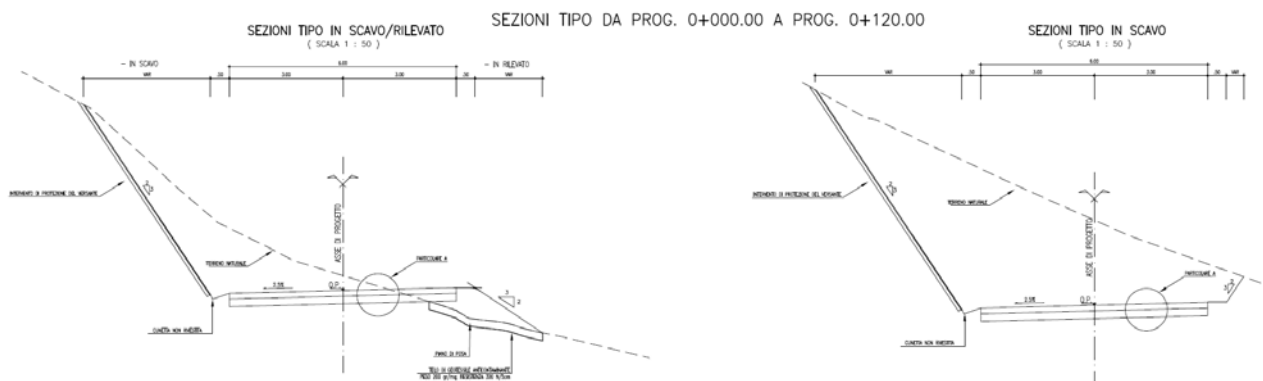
Sezione tipo strada di cantiere dalla prog. 0+000.00 alla pror. 0+120.00
